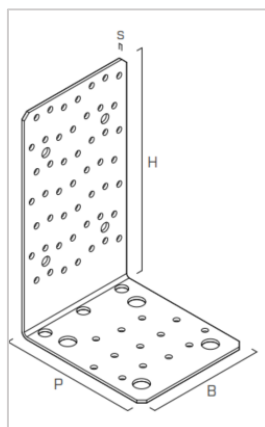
Angular prefabricado de unión de piezas de madera. Fuente: fabricante.
